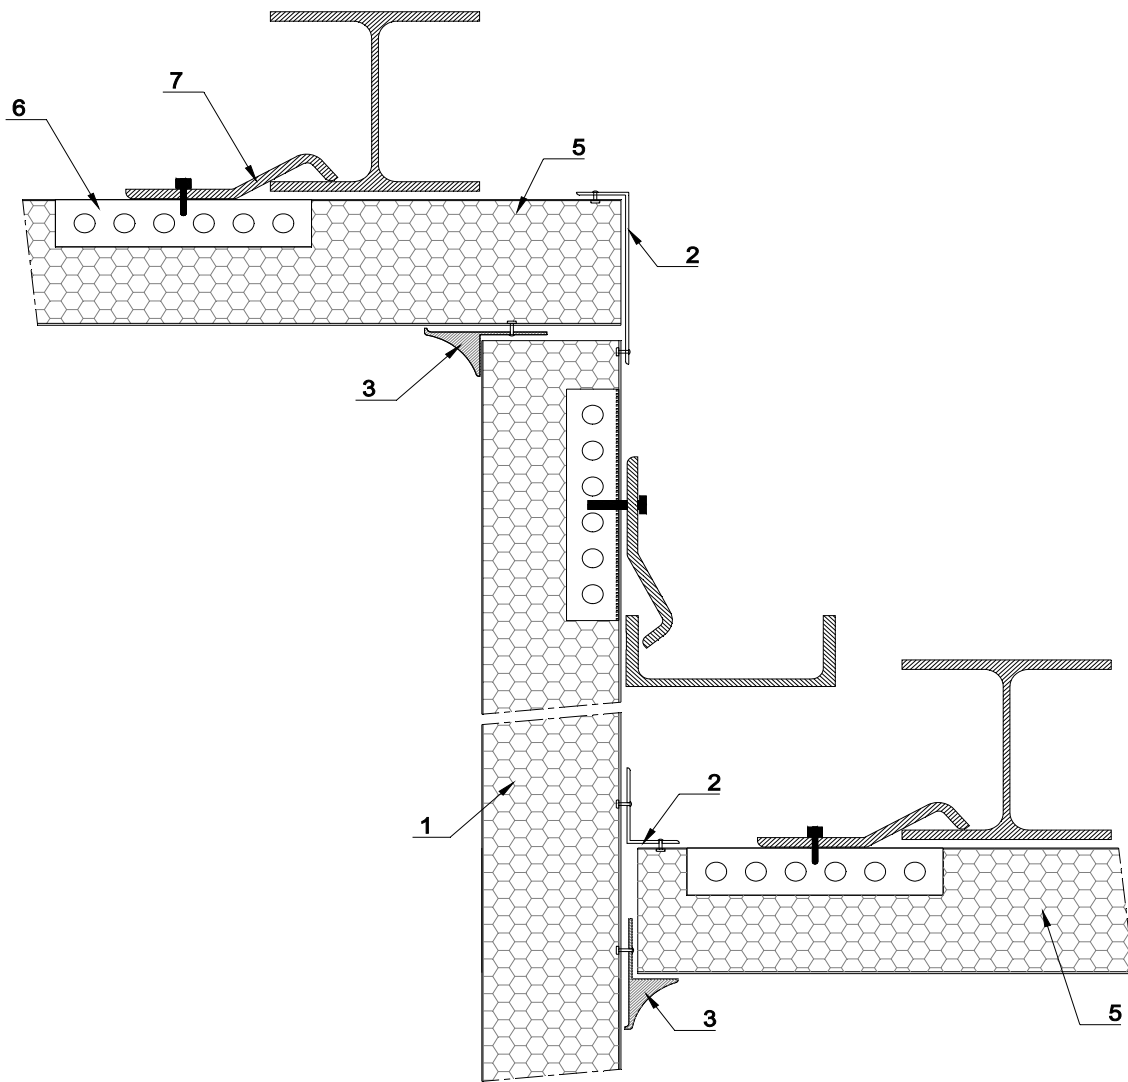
Assemblage Paroi ne supportant pas le plafond/plafond
